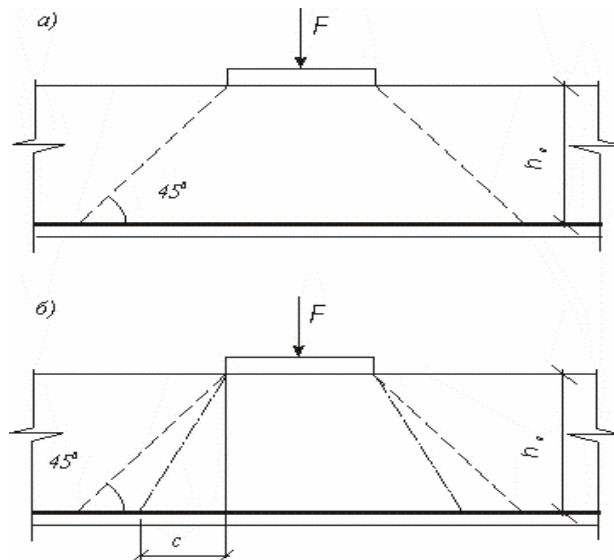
Схеми для розрахунку залізобетонних елементів на продавлення
